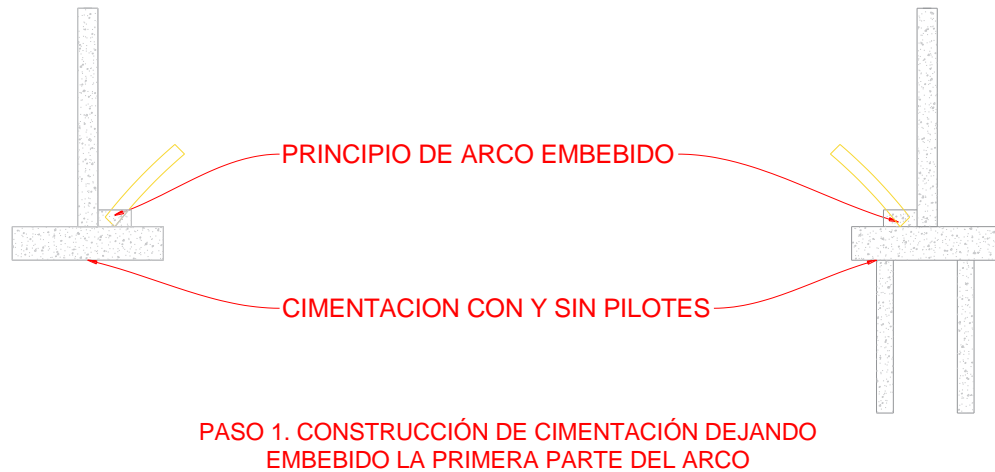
Paso 1 construcción de la cimentación del puente dejando embebido la parte inicial del arco.
